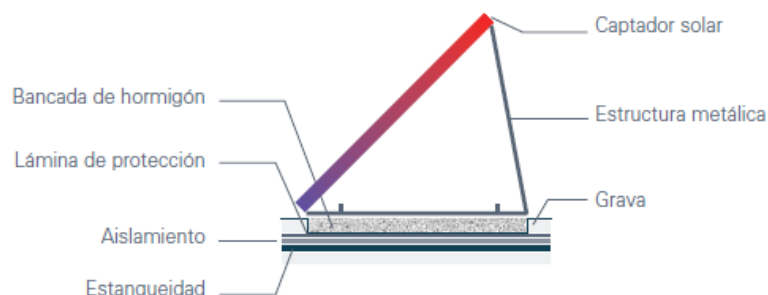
Esquema de la disposición de las zapatas de hormigón para la sujeción de la estructura.
